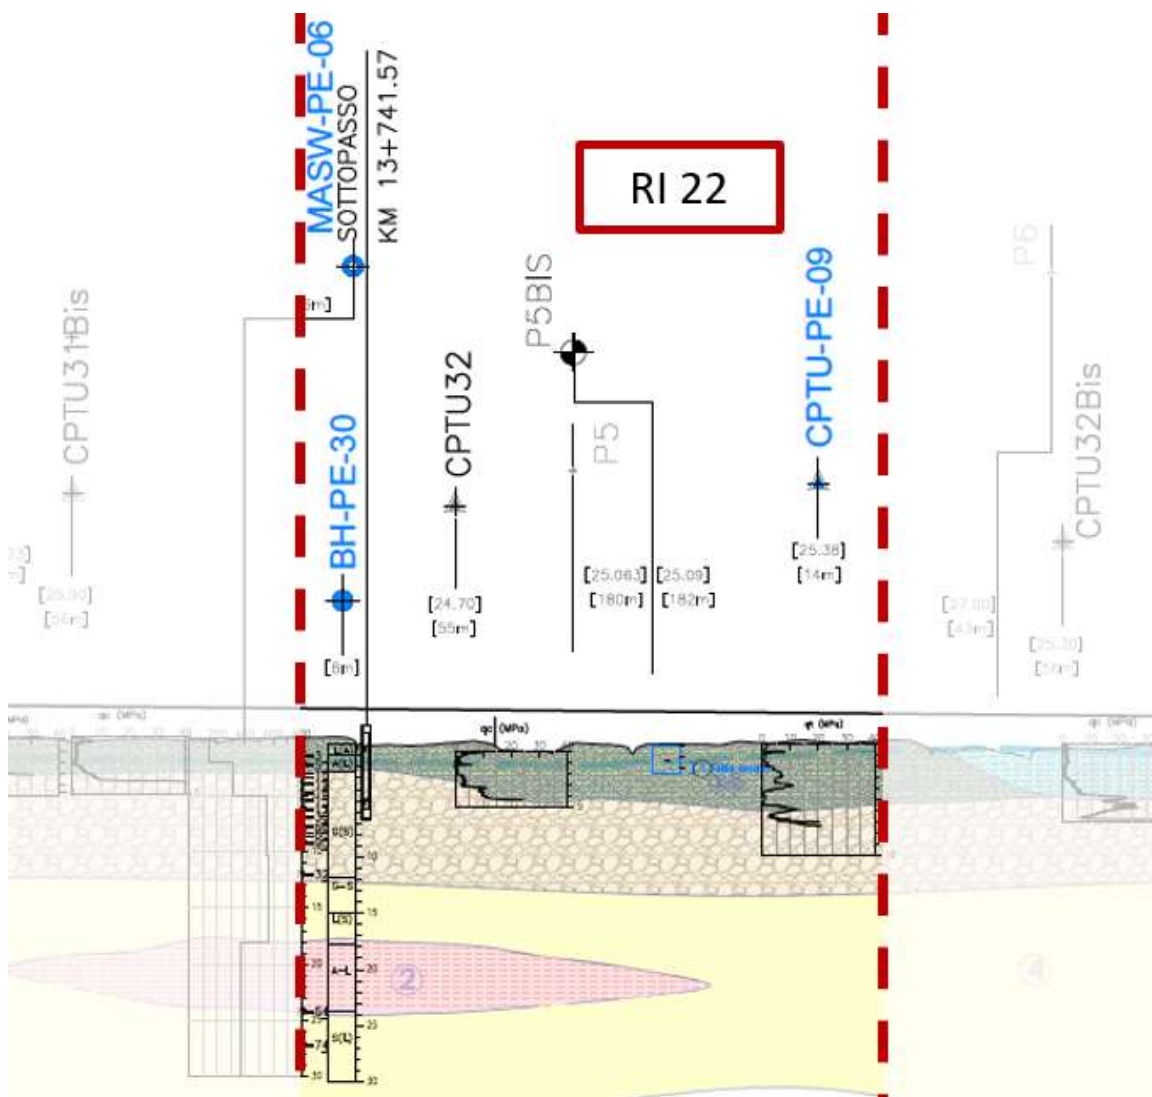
Profilo Geotecnico Rilevato RI22, estratto dal Profilo Geotecnico Generale (Doc. Rif. [4])
